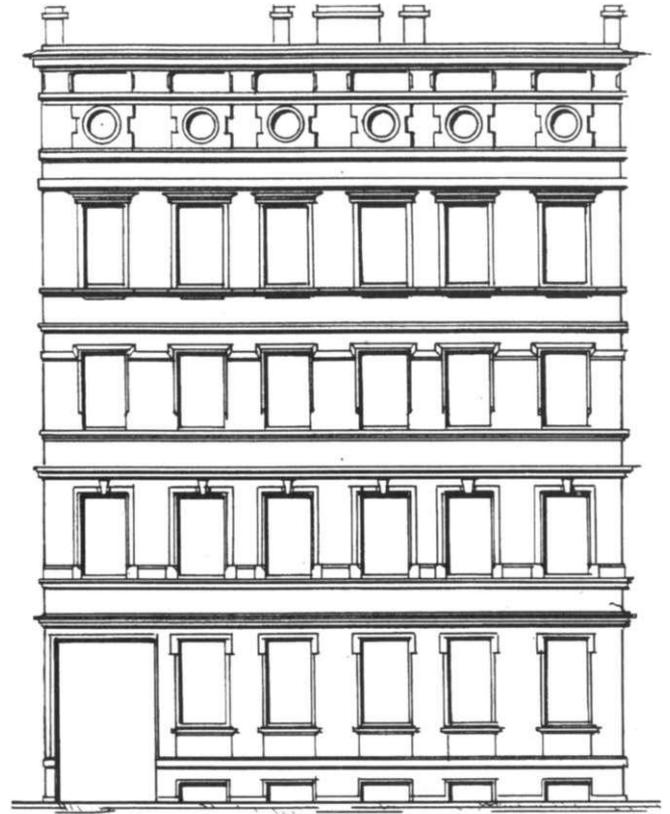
Immermannstraße 31, Fassadenaufriß Hinterhaus
